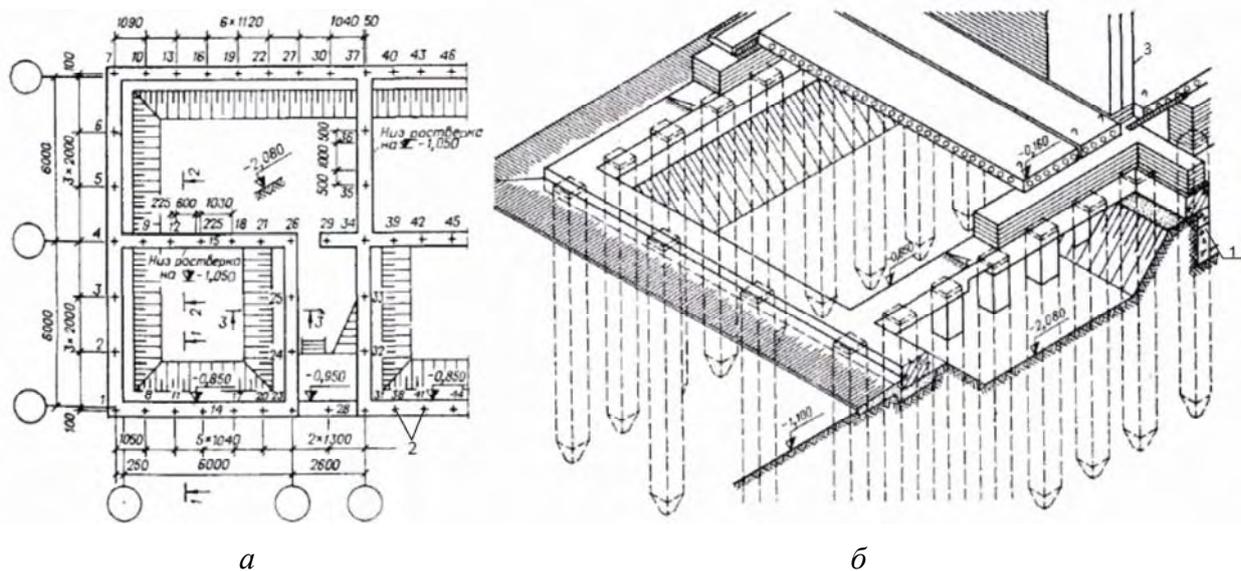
Свайные фундаменты крупноблочных зданий: *а* — фундаменты кирпичных и крупноблочных зданий, план свайного поля и монолитных ростверков; *б* — свайные фундаменты с монолитным железобетонным ростверком, общий вид фундаментов в торце здания: 1 — под ростверком подпорная стенка в пределах откоса; 2 — отметки головок свай (условно не показаны); 3 — вентиляционные блоки
